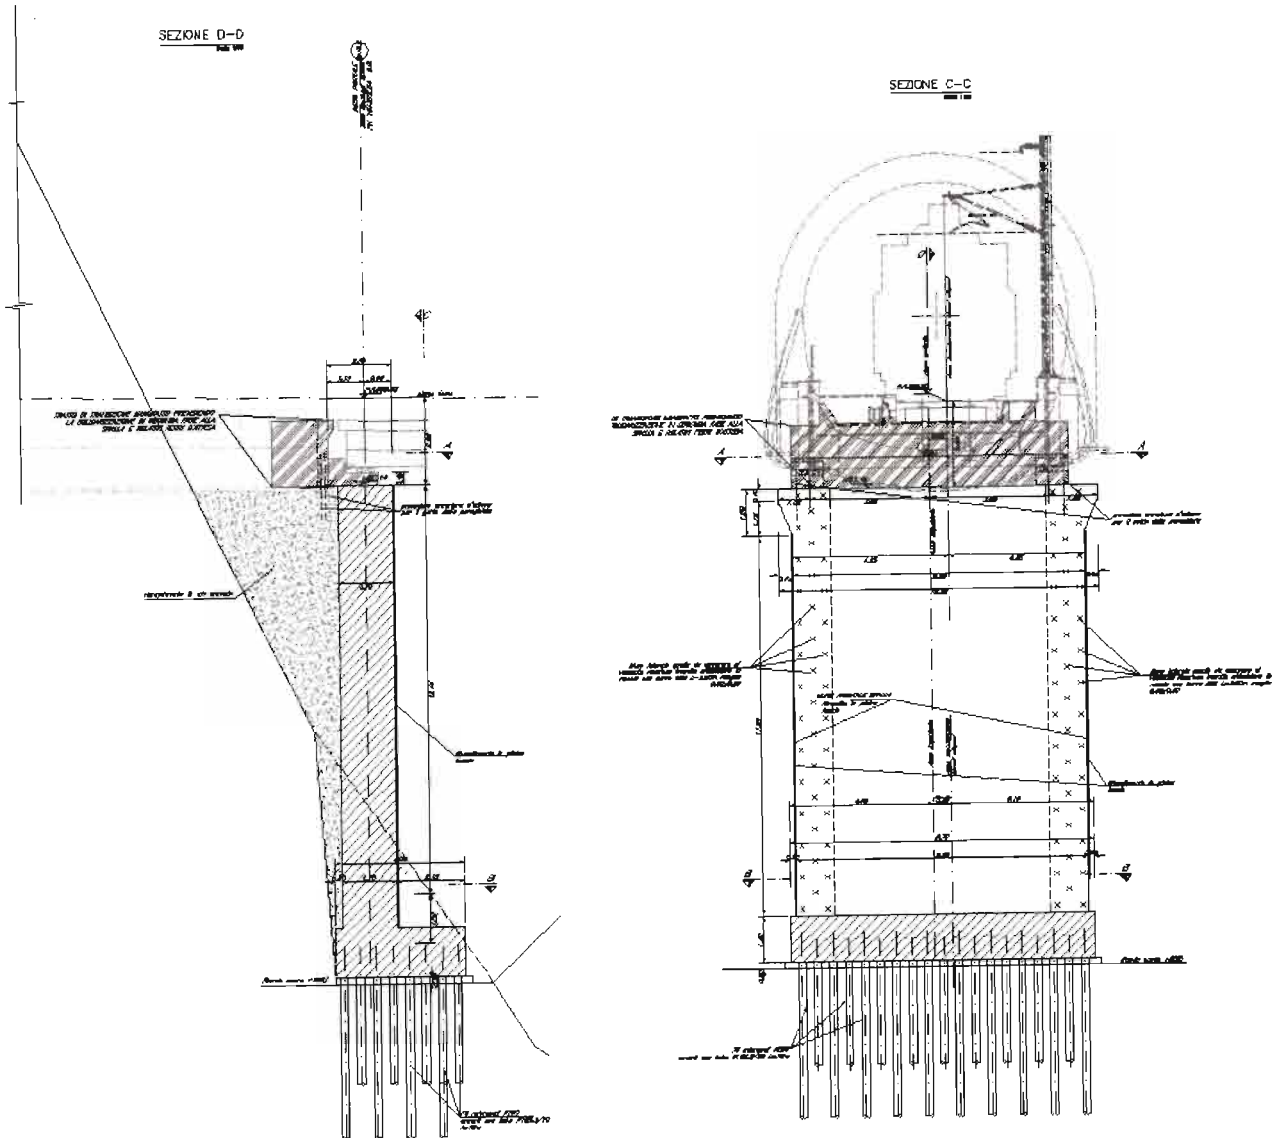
Sezione longitudinale e trasversale della spalla lato Scaleres VI02 (B.D.)
